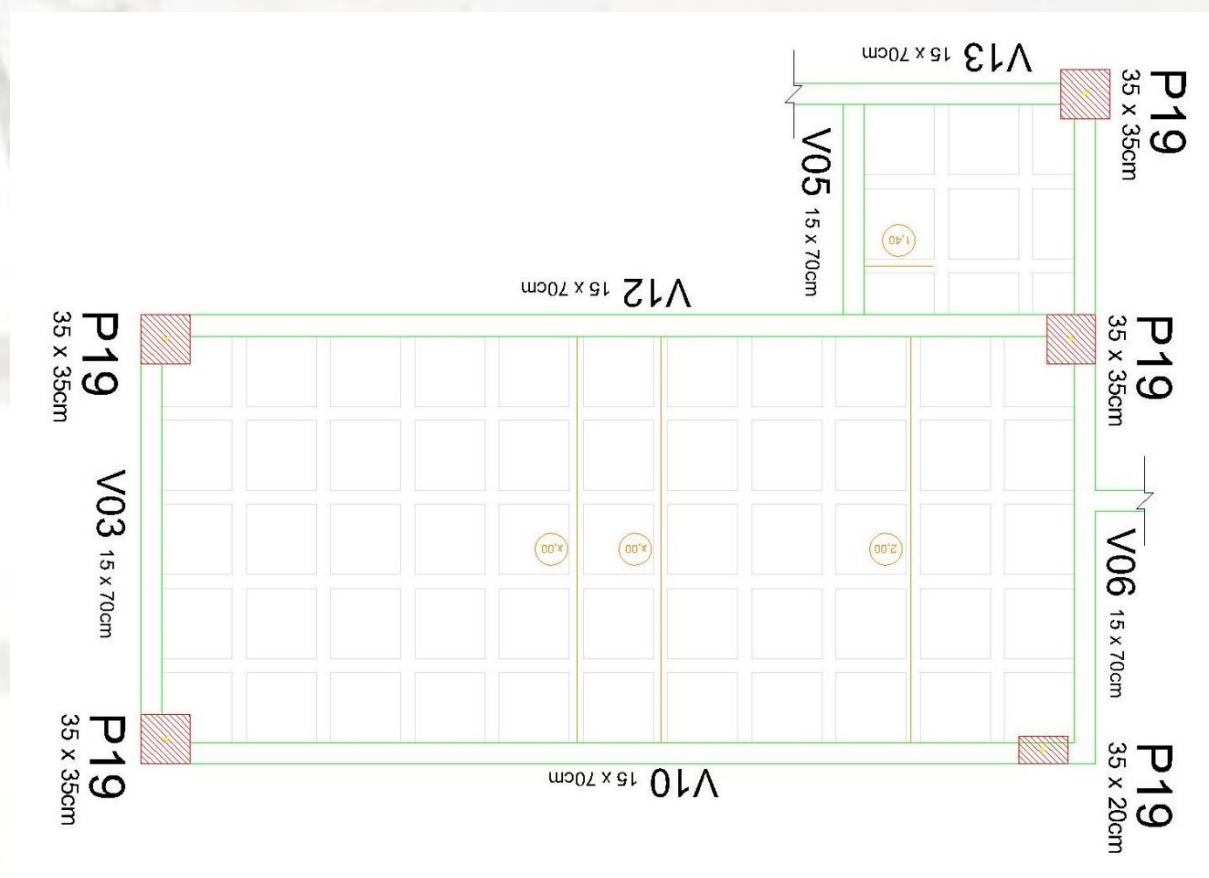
Identificação dos pontos de fissuração e medidas das suas aberturas (lajes da escada e do auditório).
